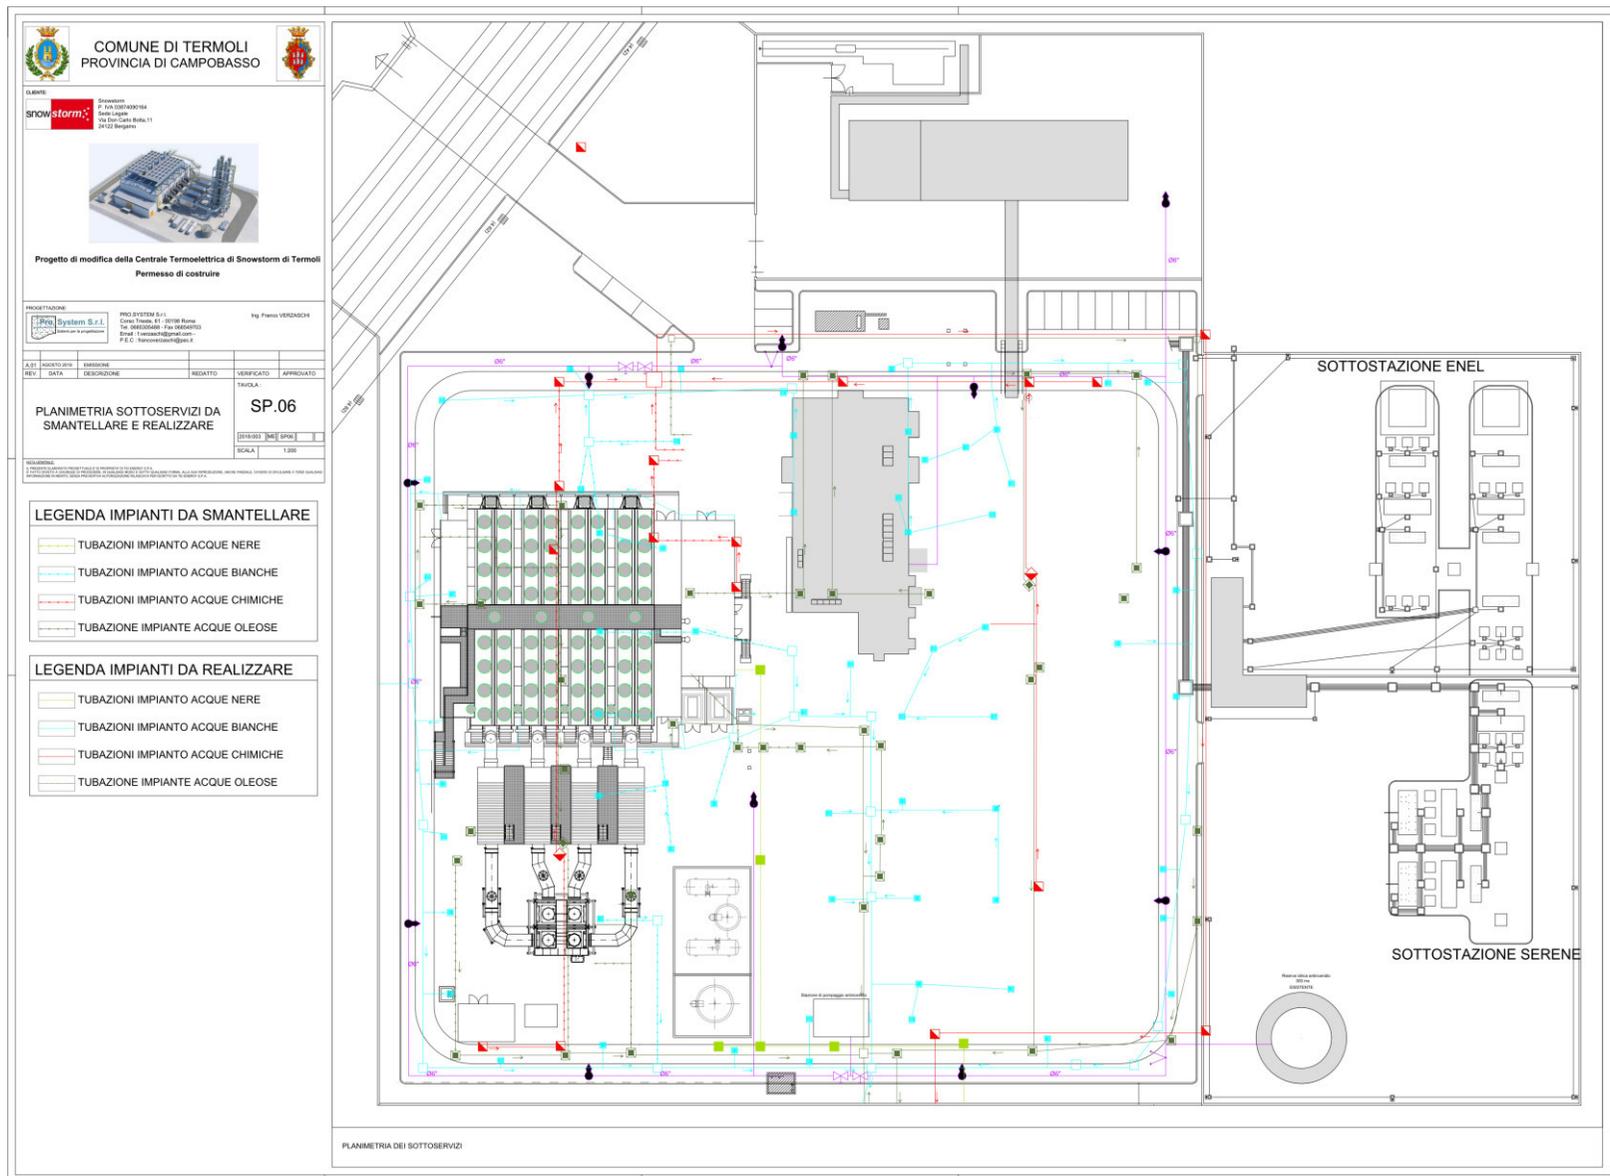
planimetria generale di stabilimento con indicazione dei sottoservizi da smantellare e realizzare: assetto "post operam"
